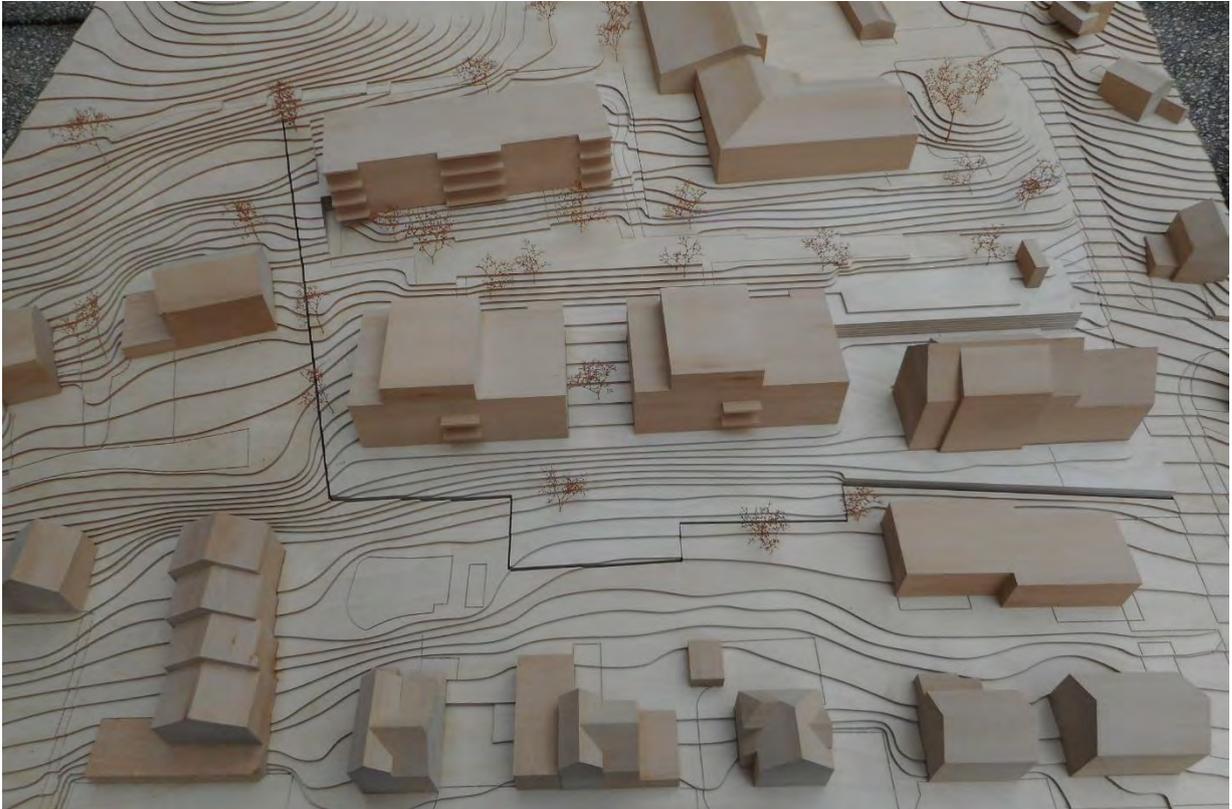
Modell Städtebauliches Konzept (Quelle Bergamini Partner Architekten)
